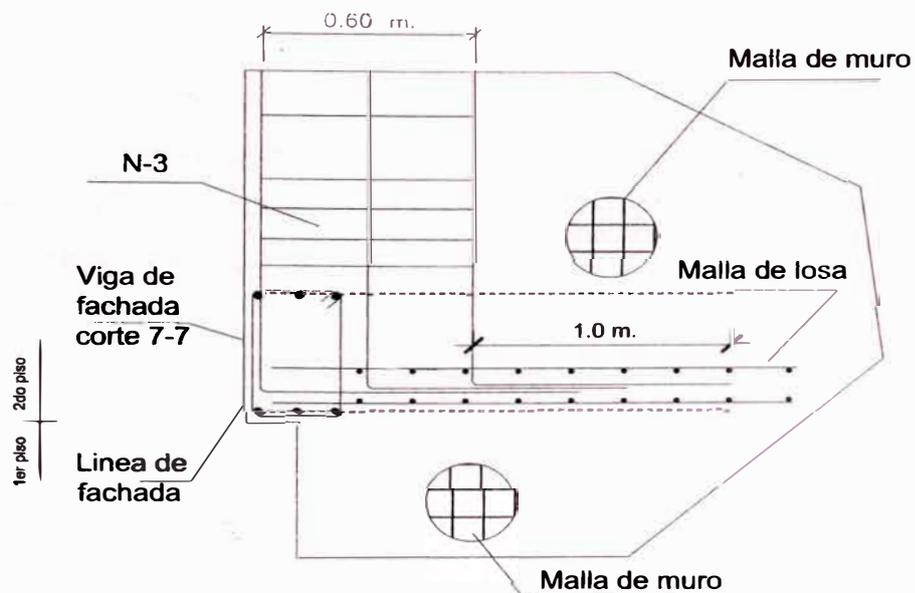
Se muestra el detalle de la unión entre el núcleo N-3, el corte de viga 7-7 y el muro. En elevación. Observe que los refuerzos de N-3 y Corte 7-7 anclan en el muro. Ver Pág. 43.
